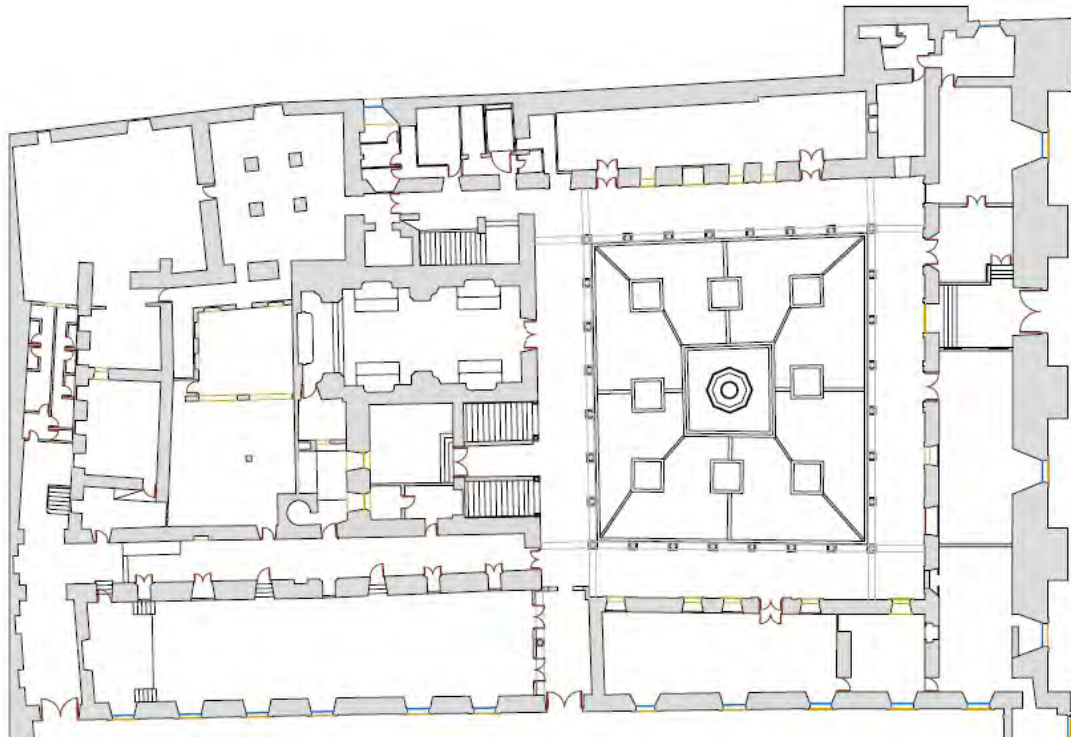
Estado previo. Planta baja. (OAFJ, fragmento del plano A01).
